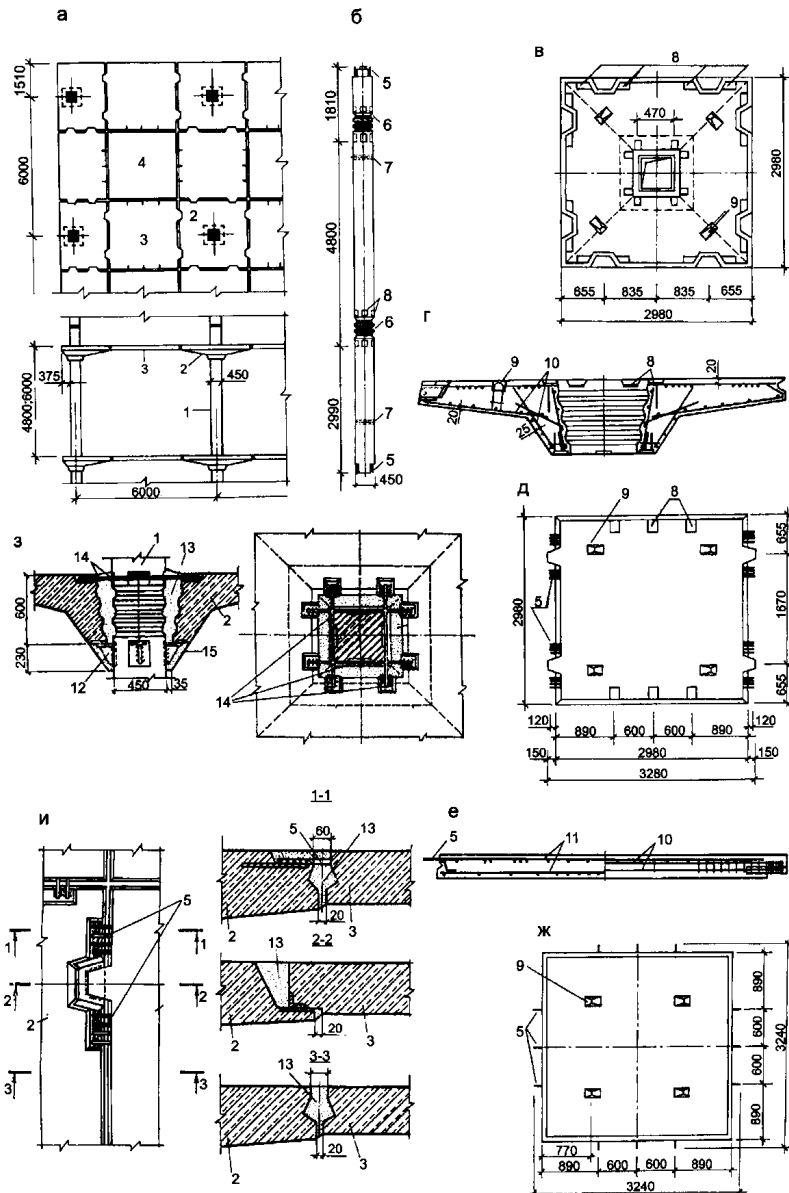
Безригельный каркас серии 1.420.1-14: а - схема формирования каркаса; б - двухэтажная колонна с высотой этажа 4,8 м; в - капитель; г - армирование капители; д - межколонная плита; е - армирование межколонной плиты; ж - пролетная плита; з - сопряжение капители с колонной; и - сопряжение межколонной плиты с капителью; 1 - колонна; 2 - капитель; 3 - межколонная плита; 4 - пролетная плита; 5 - выпуски арматуры; 6 - пазы; 7 - строповочное отверстие; 8 - закладные детали; 9 - подъемная петля; 10 - арматурный каркас; 11 - арматурные сетки; 12 - стальные монтажные столики; 13 - бетон замоноличивания; 14 - арматурные вставки; 15 - обетонировка монтажных столиков
